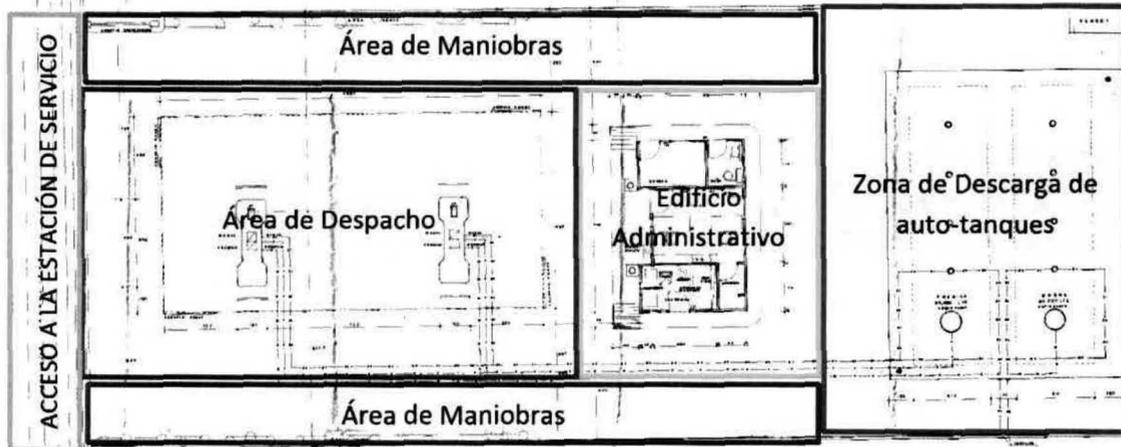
Plano de conjunto de la Estación de Servicio.
